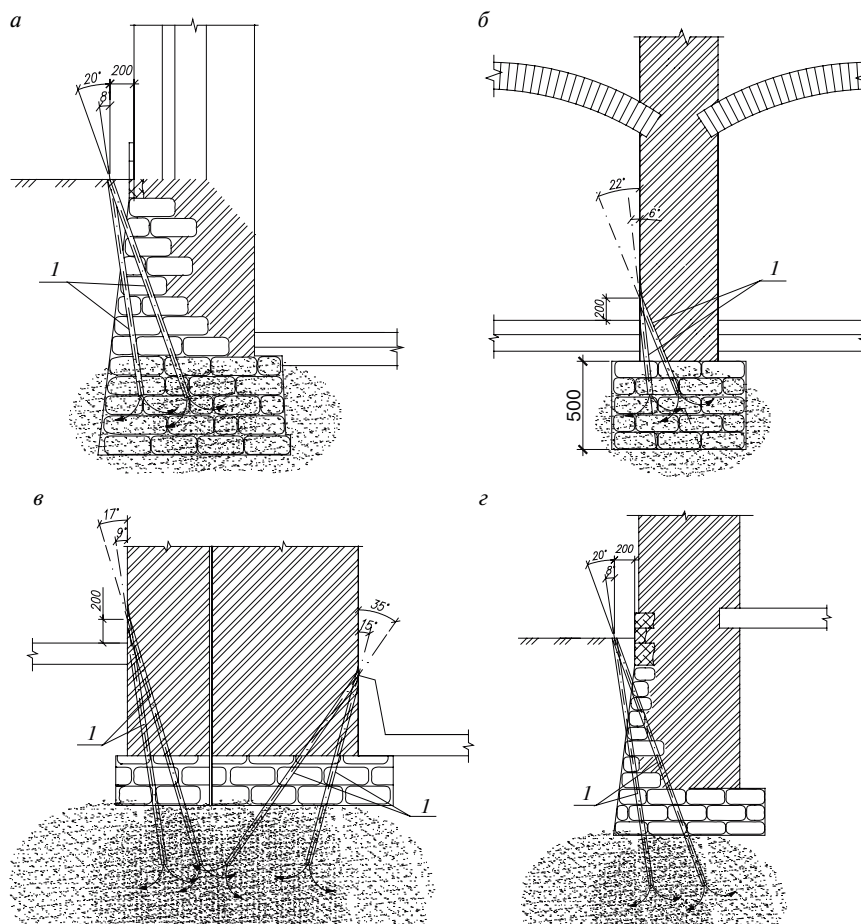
Схемы производства цементационных работ по усилению тела фундаментов и контактного слоя: а, б — цементация тела фундаментов; в, г — цементация контактного слоя основания с фундаментом: 1 — цементационные скважины — ЭРТ
